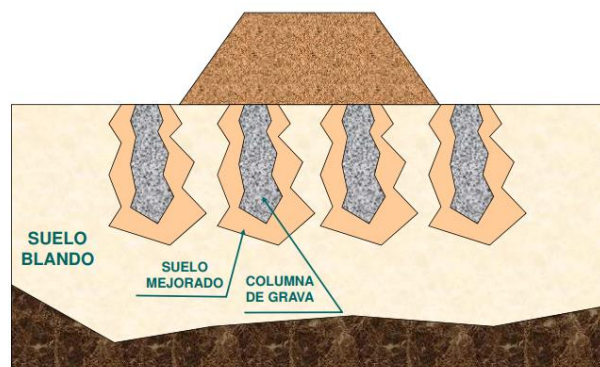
Esquema tratamiento columnas de grava (Fuente: Asignatura Obras geotécnicas).
